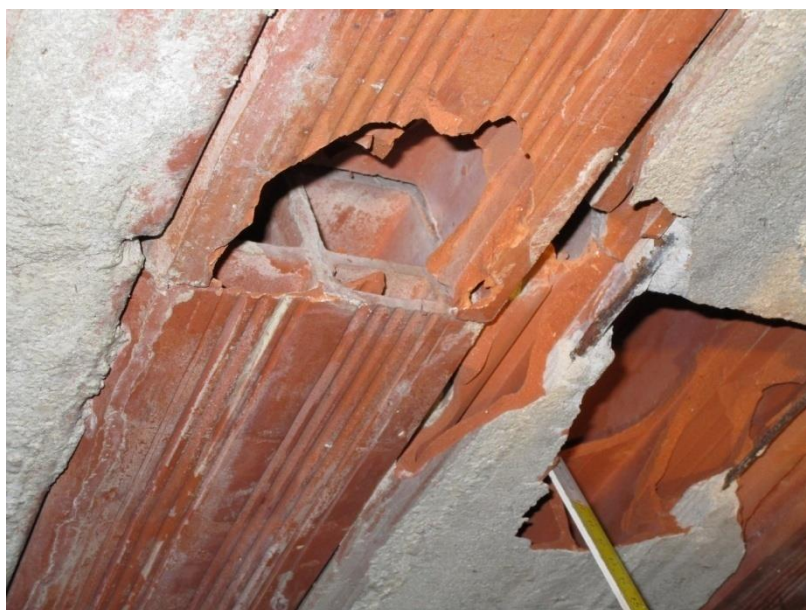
copertura S.06: dettaglio dei blocchi di alleggerimento alternati ai travetti armati in laterizio
